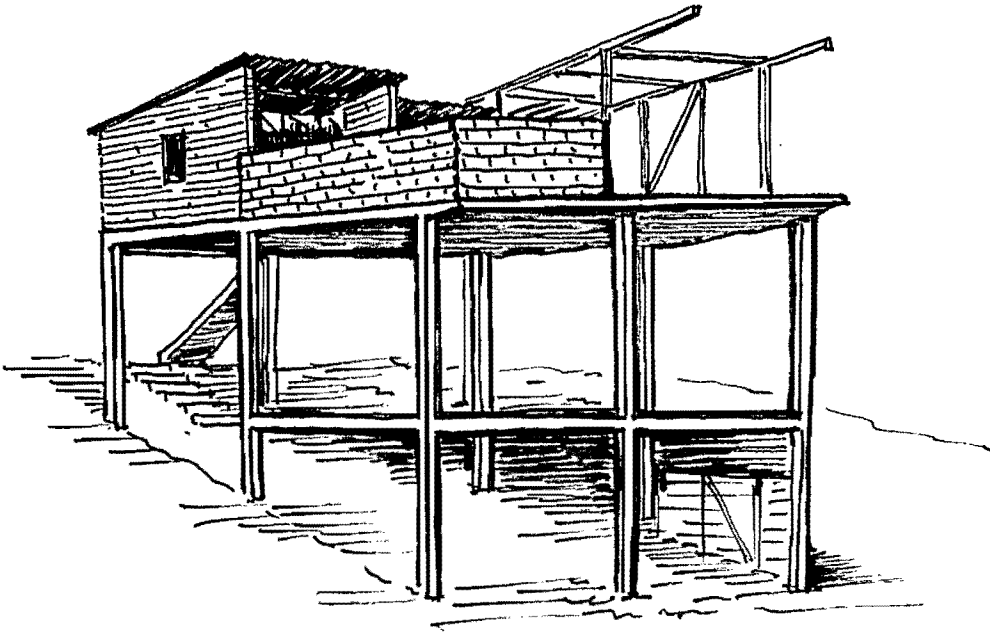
SISTEMA DE VIGAS Y COLUMNAS
